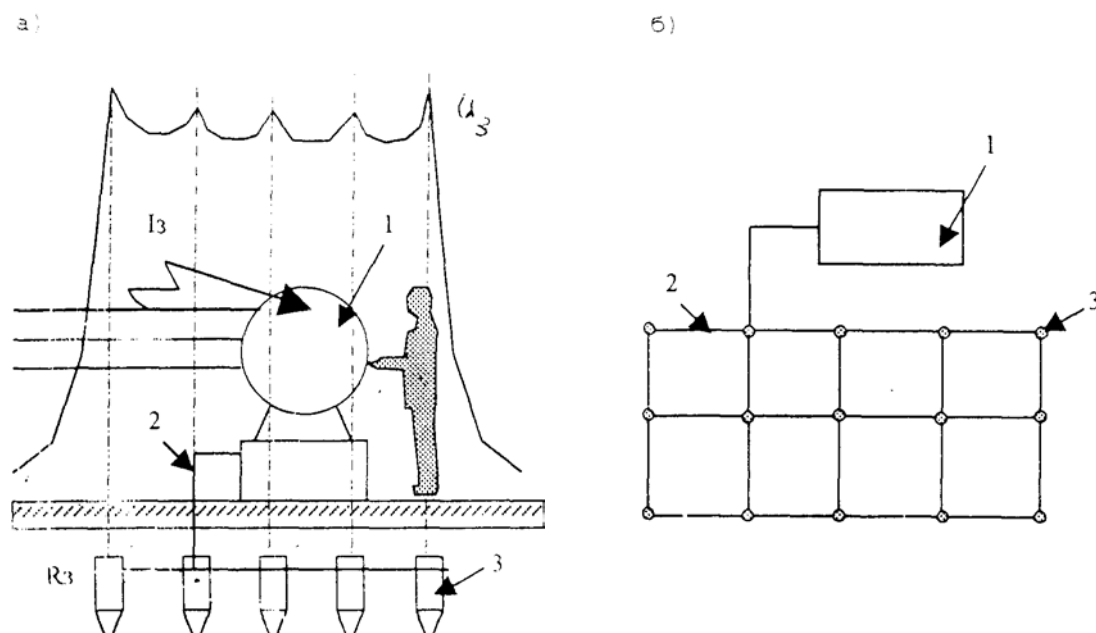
Контурное заземление: а - разрез; б - вид в плане;
